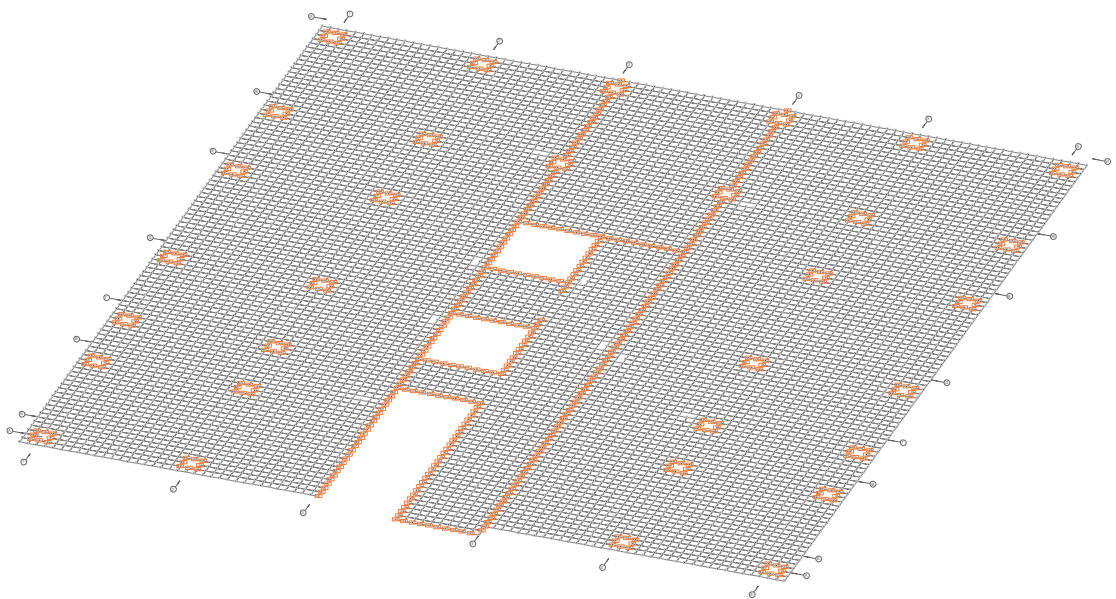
Расчетная схема рассматриваемой плиты перекрытия
